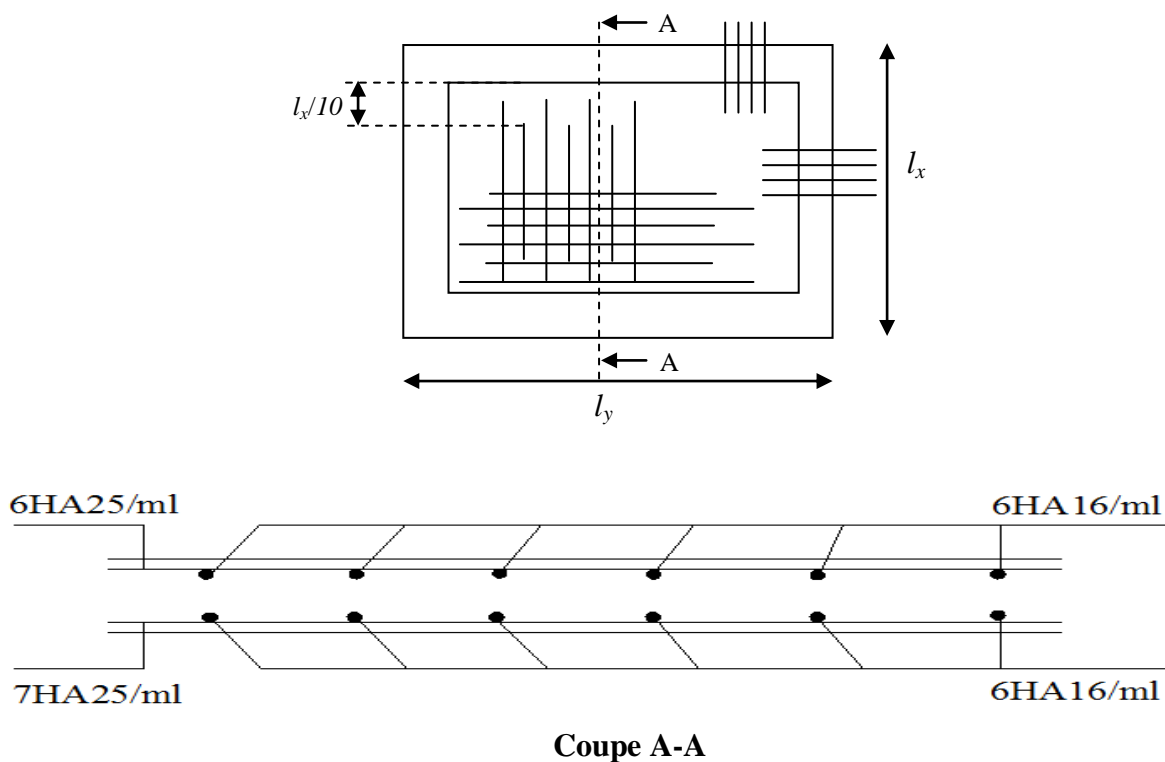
Schéma de ferrailage de la dalle de radier
